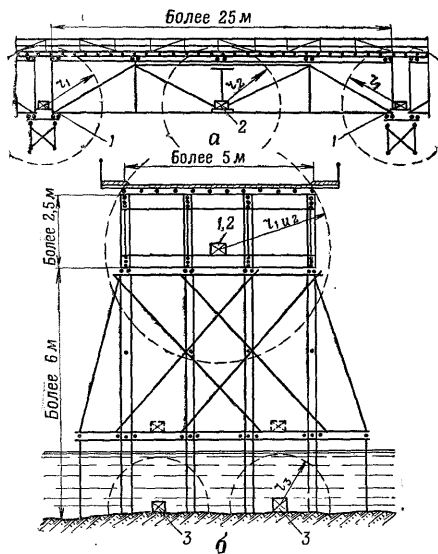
Подрывание высоководного деревянного моста с ригельно-раскосными фермами:
